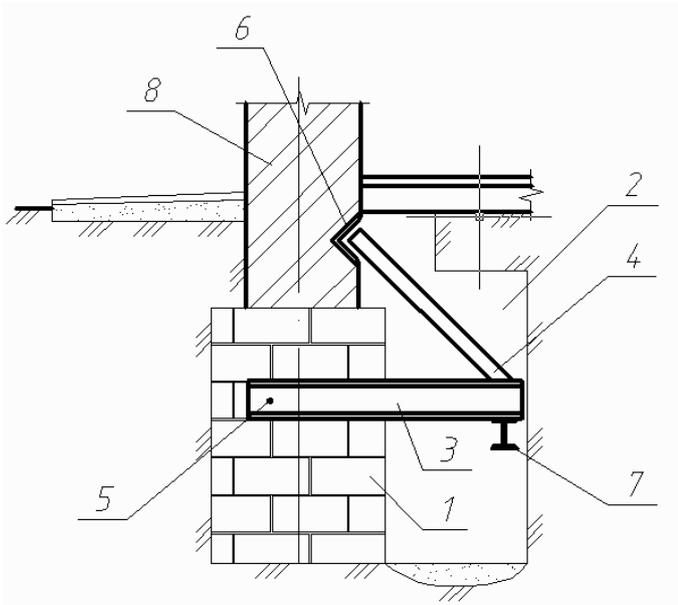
Уширение опорной площади ленточных фундаментов устройством одностороннего бетонного банкета: 1 – усиливаемый фундамент; 2 – монолитный бетонный банкет; 3 – несущая балка; 4 – подкос; 5 – анкер; 6 – упорный уголок; 7 – распределительная балка; 8 – кирпичная стена; 9 – зона уплотненного грунта
